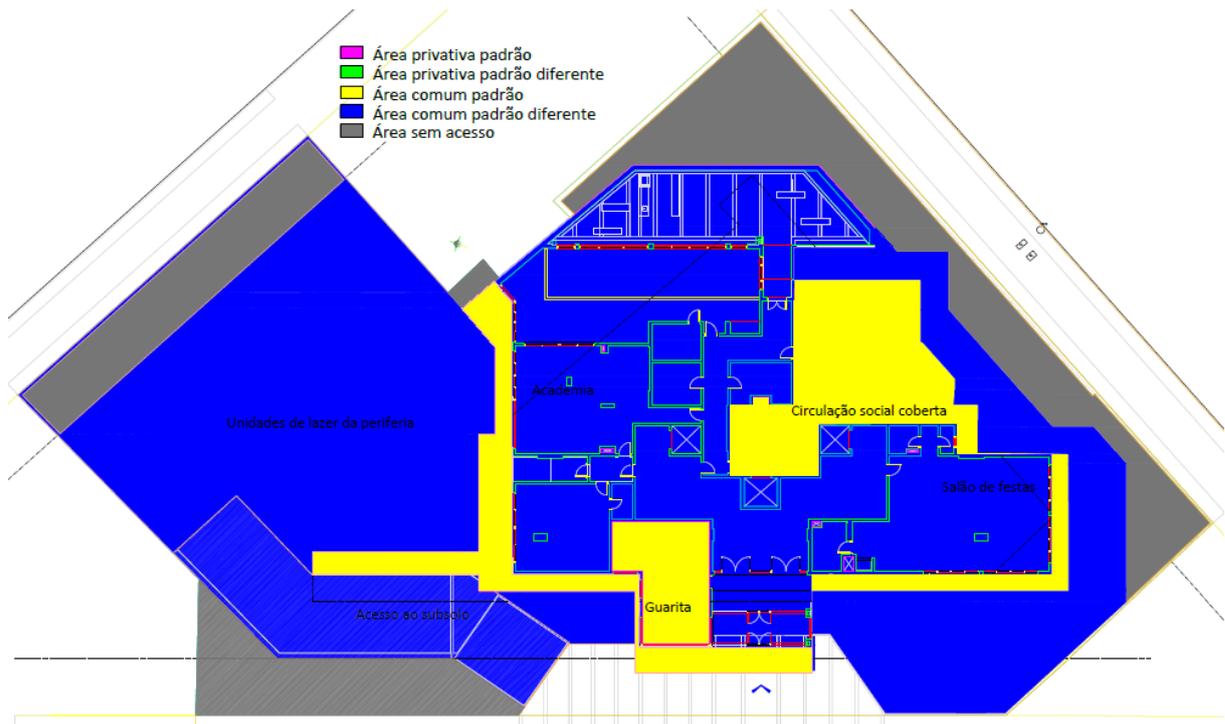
Divisão de áreas do primeiro subsolo do Projeto A
